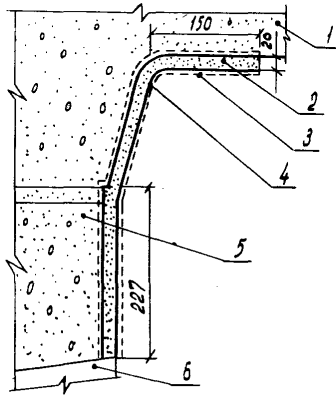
Рис. I. Утепление внутренних поверхностей стен (вертикальный разрез стены в доме серии ТКГ-480): 1 - панель перекрытия, 2 - перлитобетон, 3 - гидрофобное покрытие, 4 - цементный раствор, 5 - наружная стеновая панель, 6 - оконный проем.
